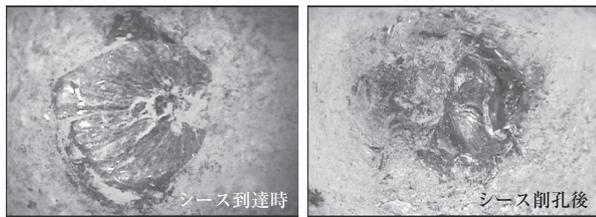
シース管内部状況 (斜め方向ひび割れ)
